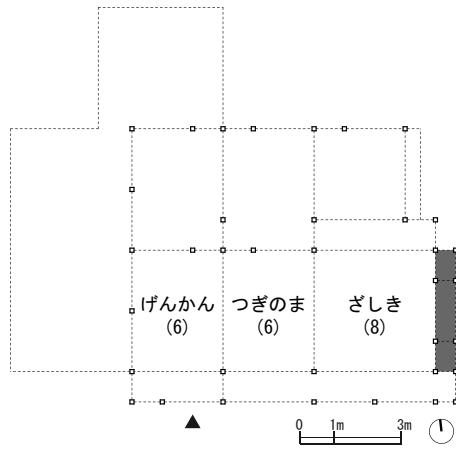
Sa家住宅家住宅復元平面図（江戸後期：19世紀初期）
